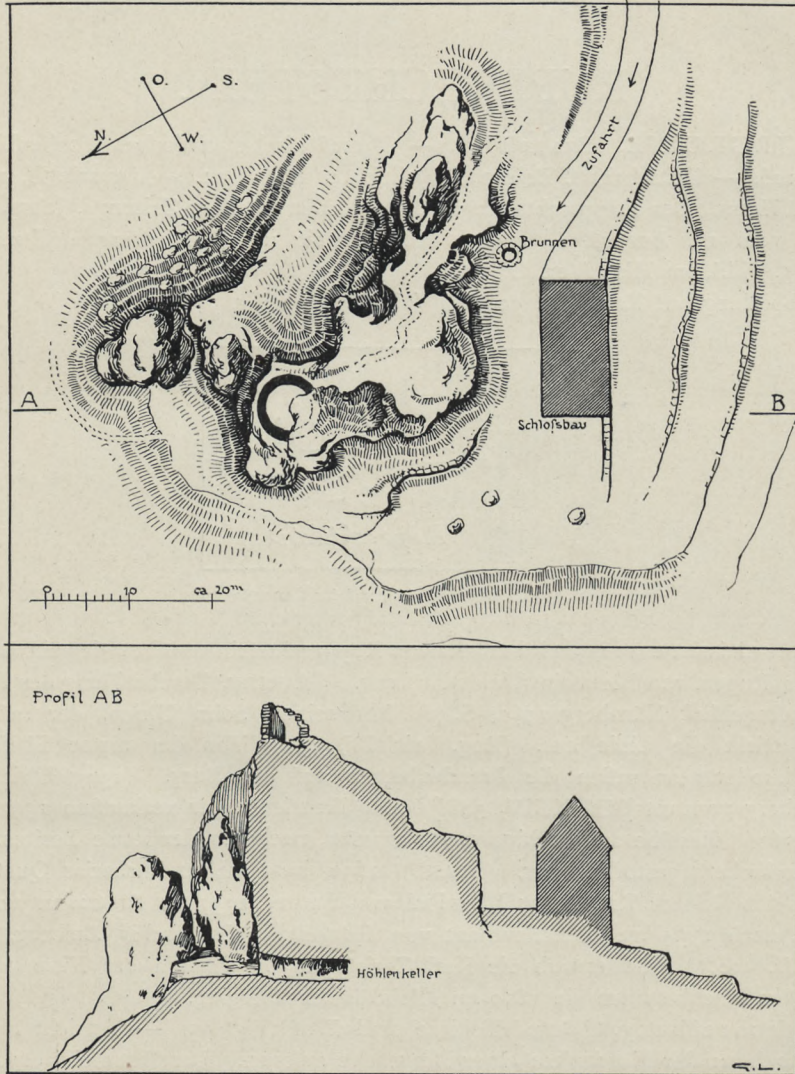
Rupprechtstein. Grundrißskizze und Profil der Burgruine.
